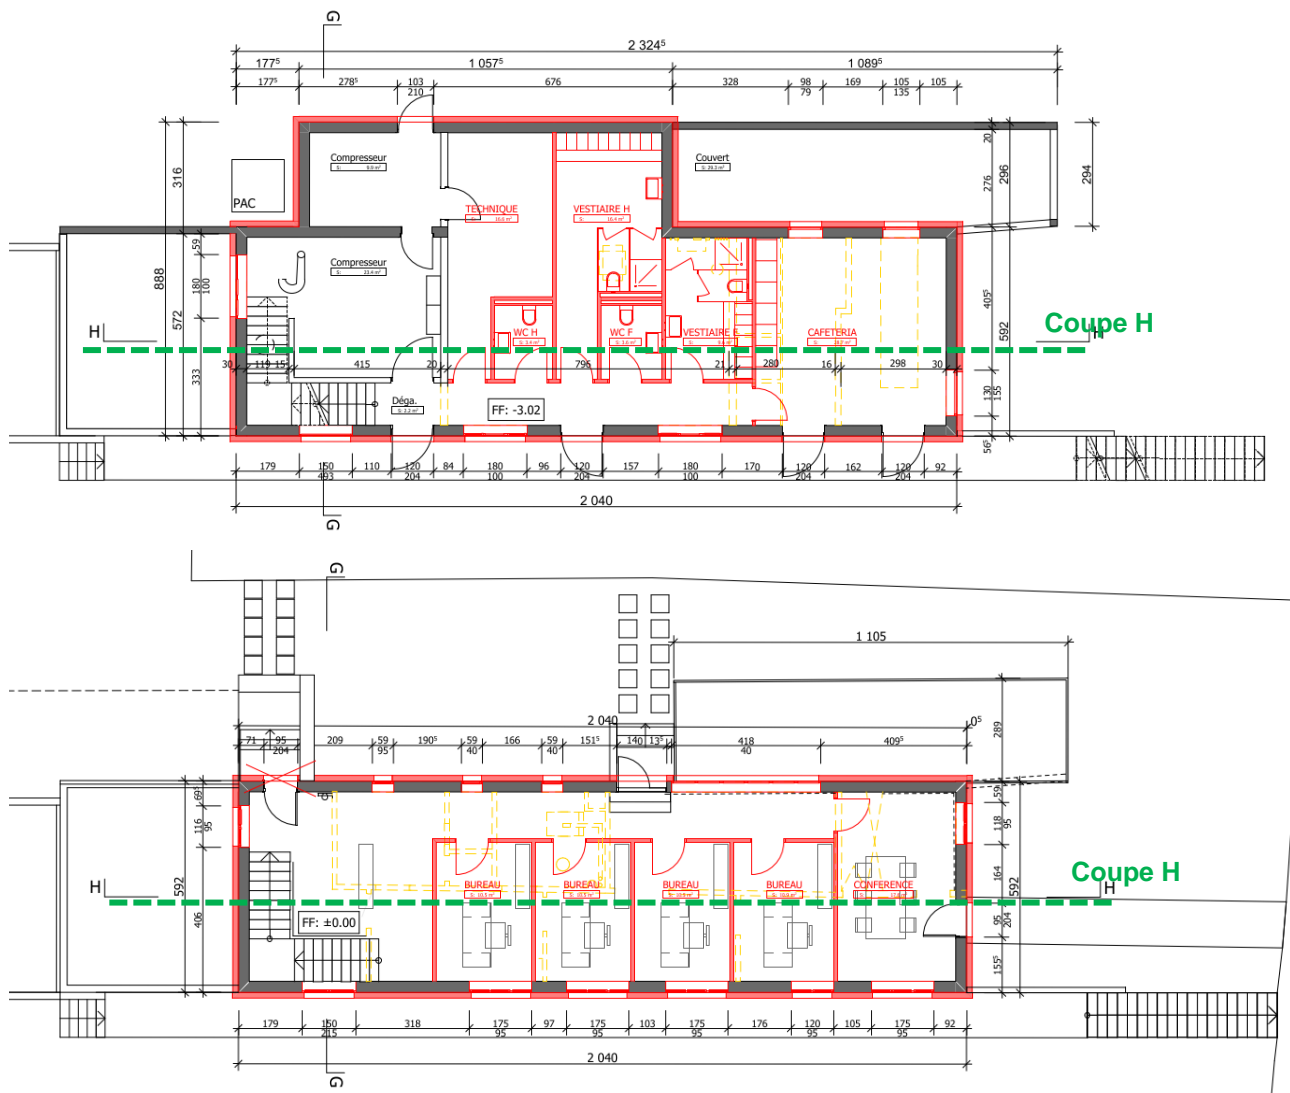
Plan de coupe du bâtiment existant au nord-est de la zone de projet. La coupe H est indiquée en vert. Extrait de [1].
